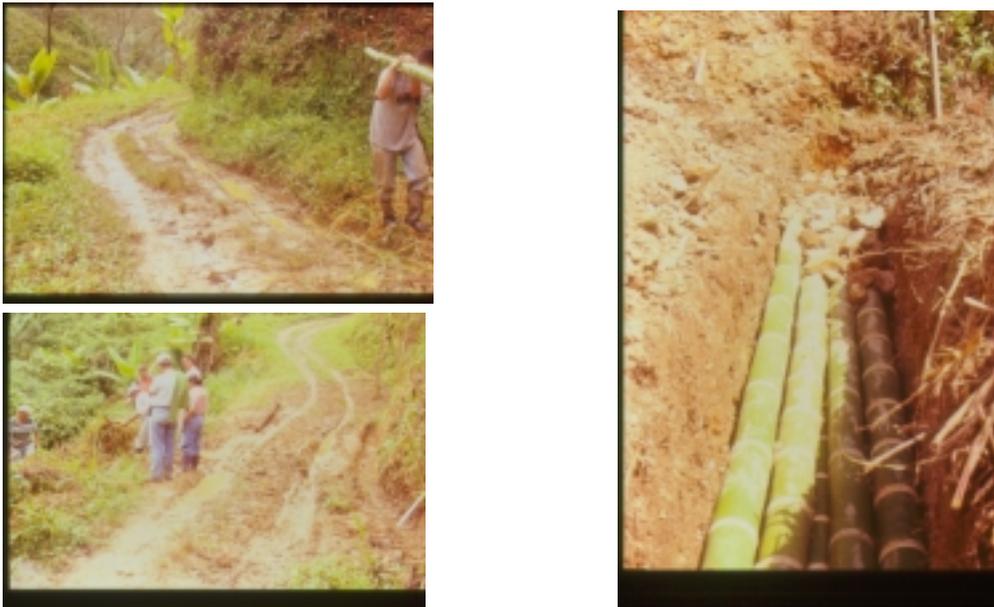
Construcción de filtros vivos atravesando banca de carretera para su drenaje. Noviembre 8 de 2002.
